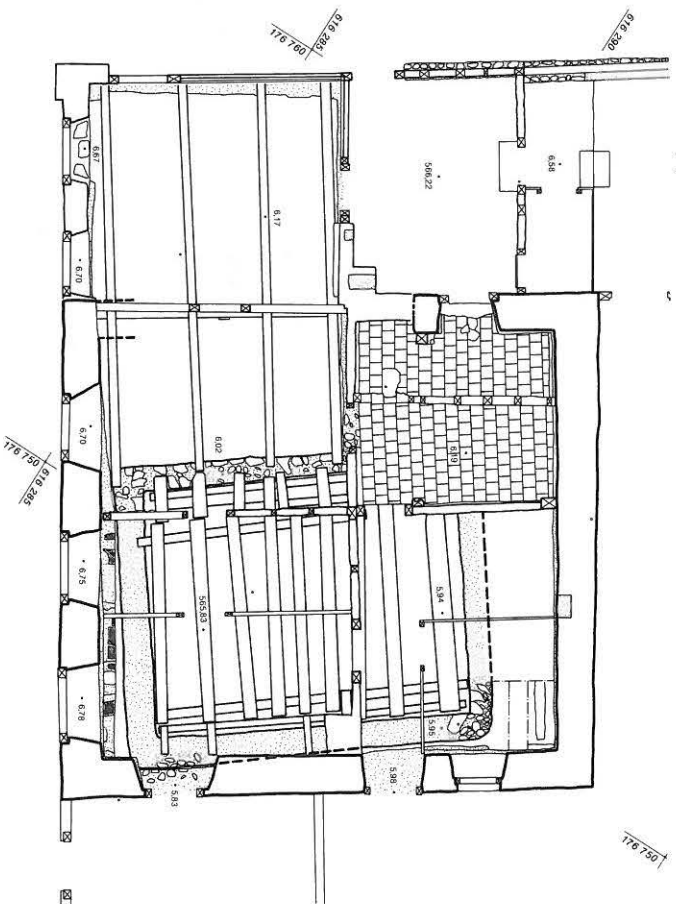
Grundriss des Erdgeschosses. M. 1:150.
